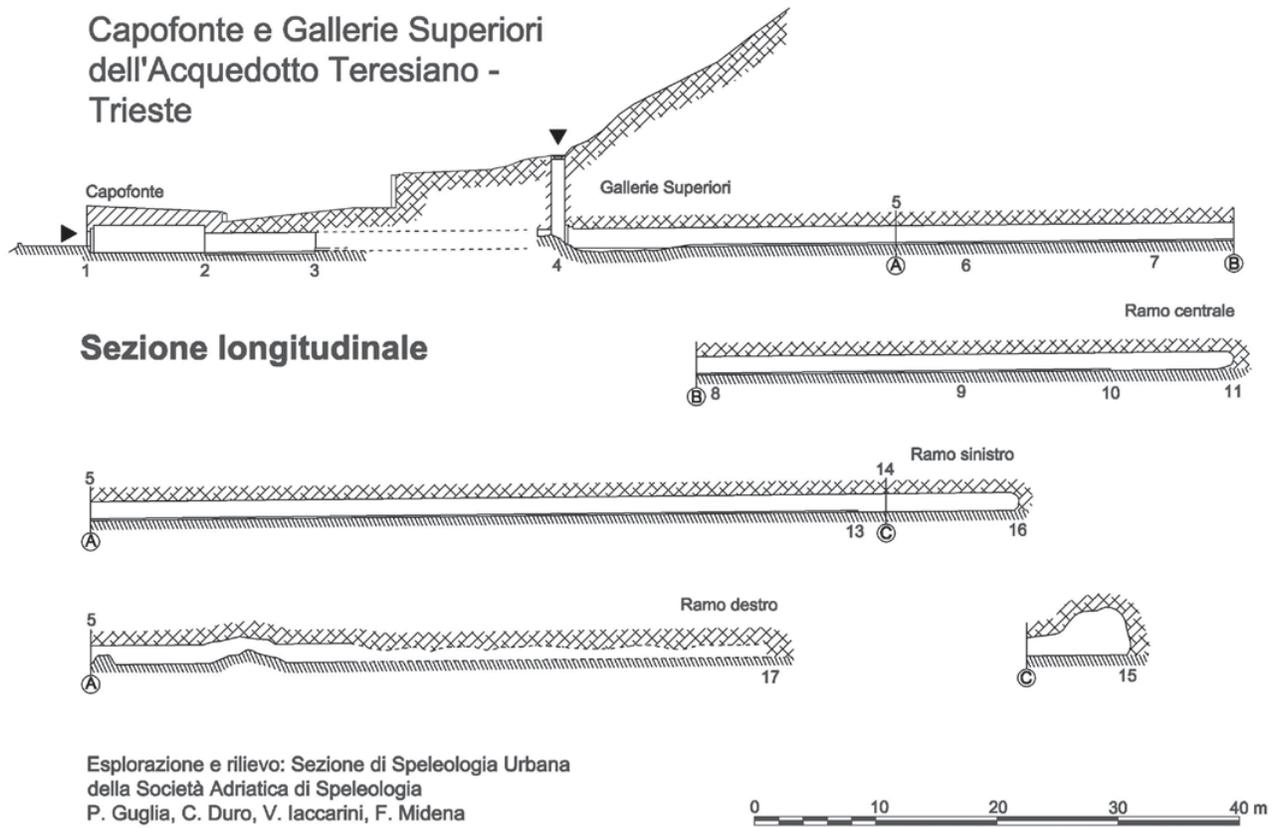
Sezione longitudinale del complesso formato dal Capofonte e dalle Gallerie Superiori.
